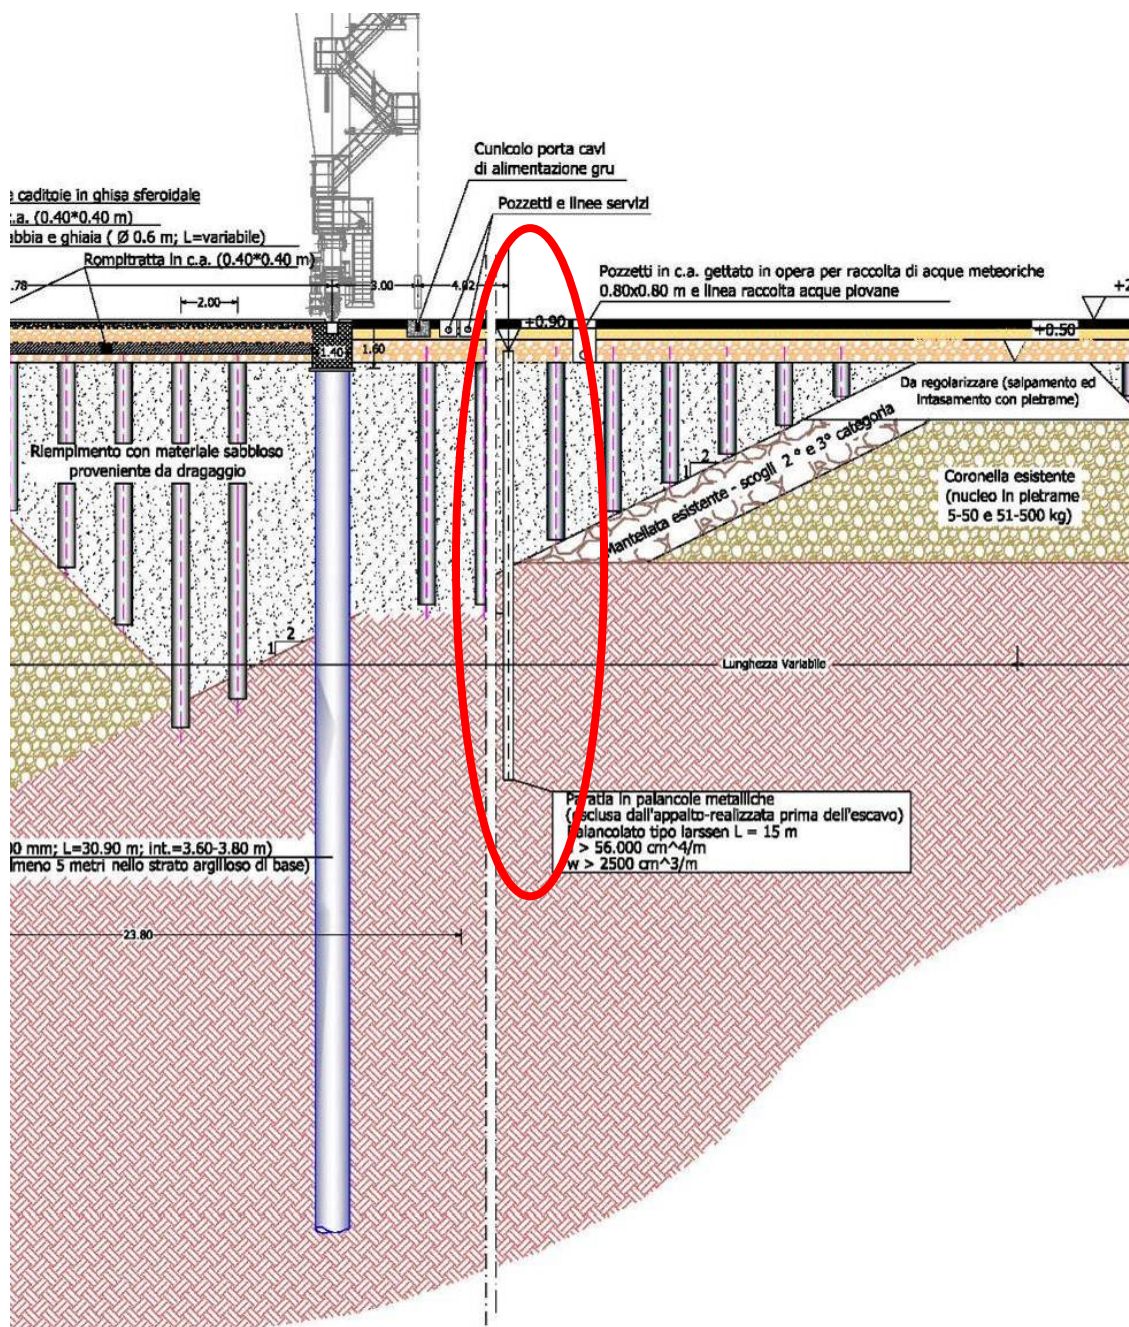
Dettaglio della sezione di progetto esecutivo banchina 27
